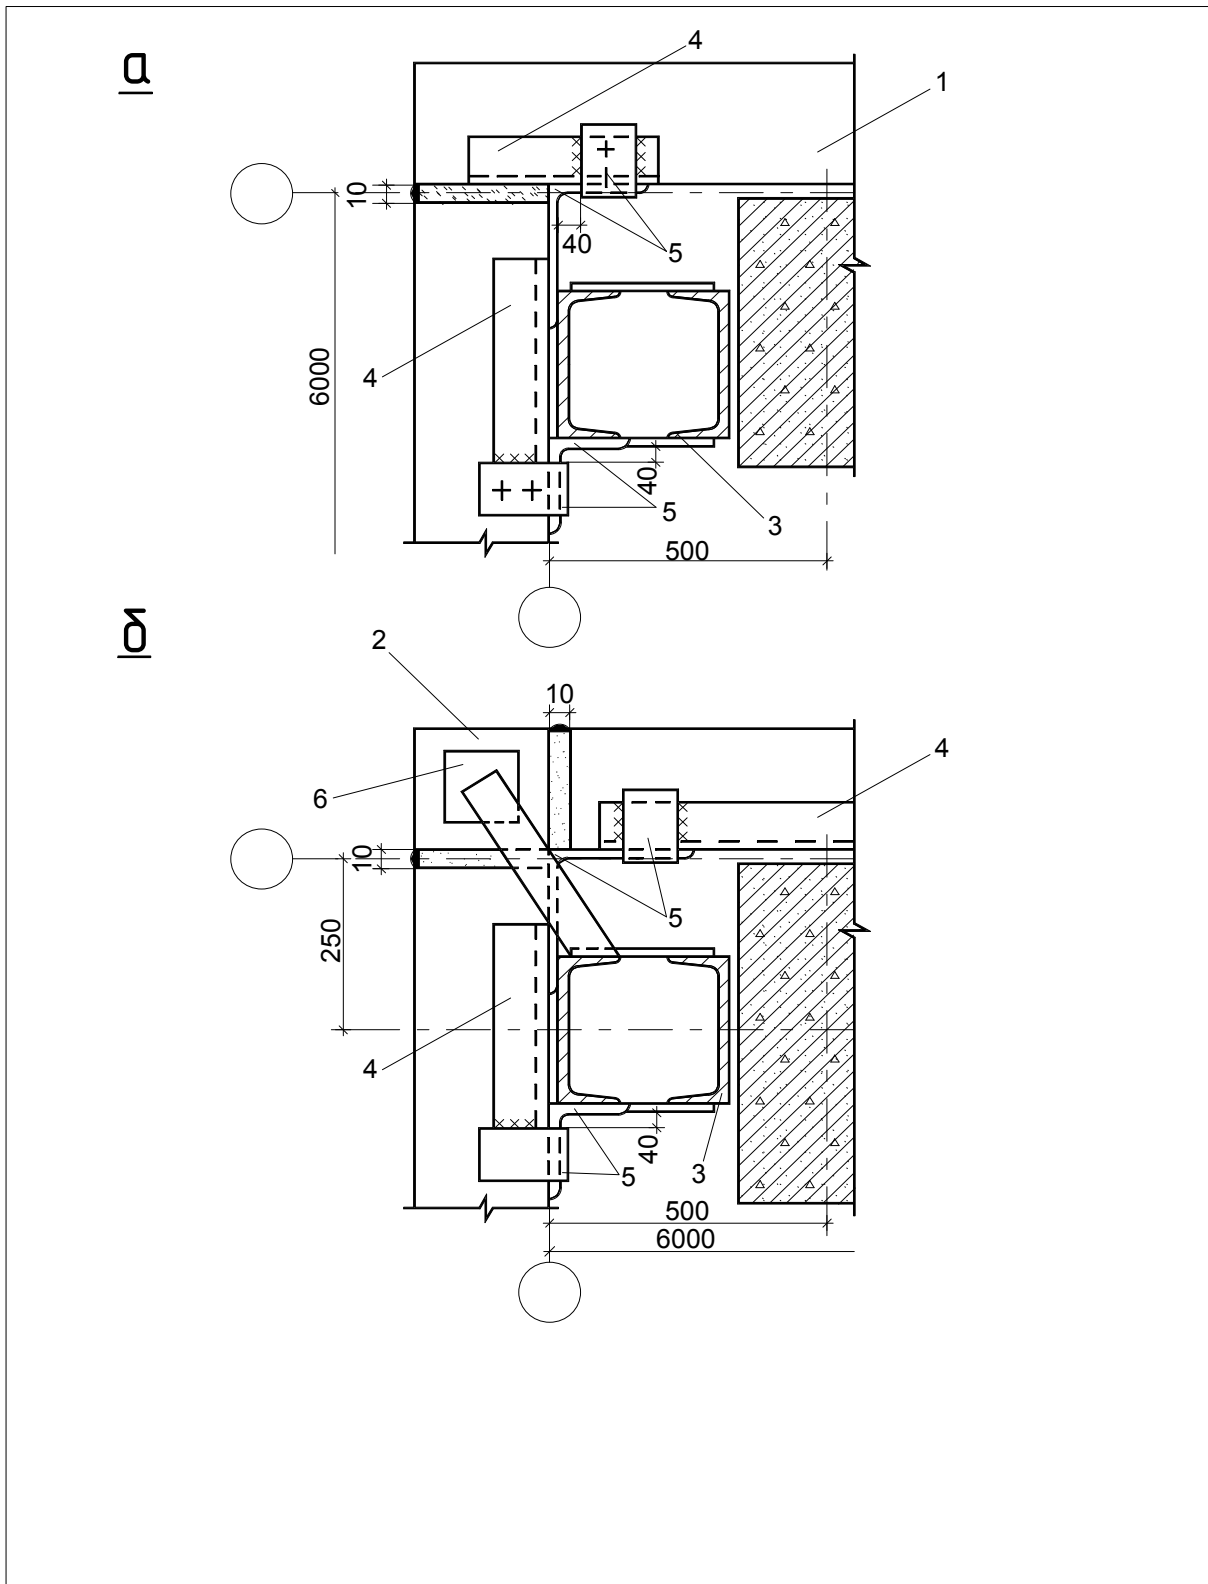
Кріплення стінових панелей до стояка торцевого фахверка в кутку будівлі на рівні низу вікна: а – варіант з подовженими панелями; б – варіант з кутовими блоками. 1 – подовжена стінова панель; 2 – кутовий блок; 3 – стояк торцевого фахверка; 4 – закладні елементи стін панелі; 5 – деталі кріплення панелі до стояка; 6 – деталь кріплення кутового блока до стояка фахверка
